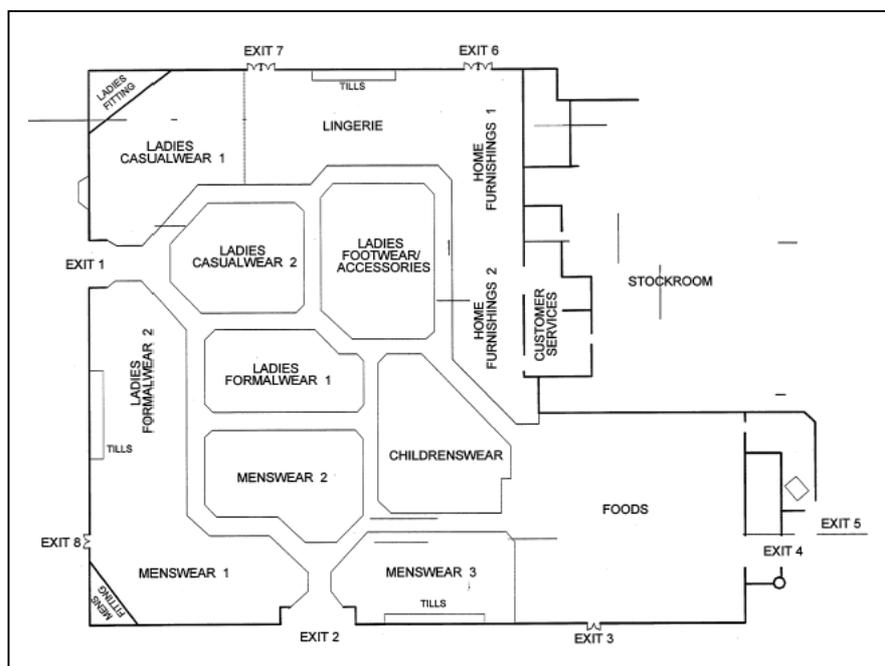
瑪莎百貨culverhouse cross 店平面圖
